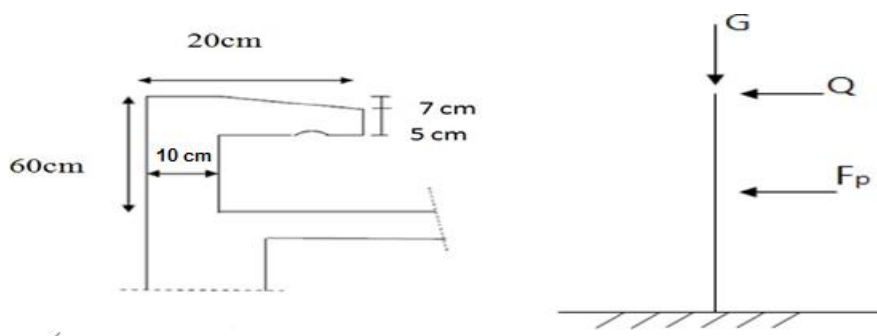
coupe en élévation de l'acrotère terrasse inaccessible.
